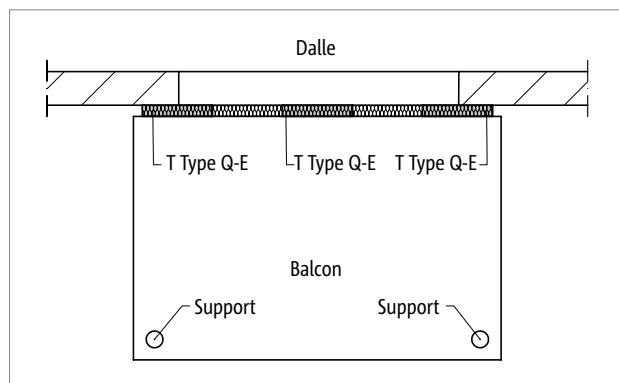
Schöck Isokorb® T Type Q-E : Balcon soutenu
